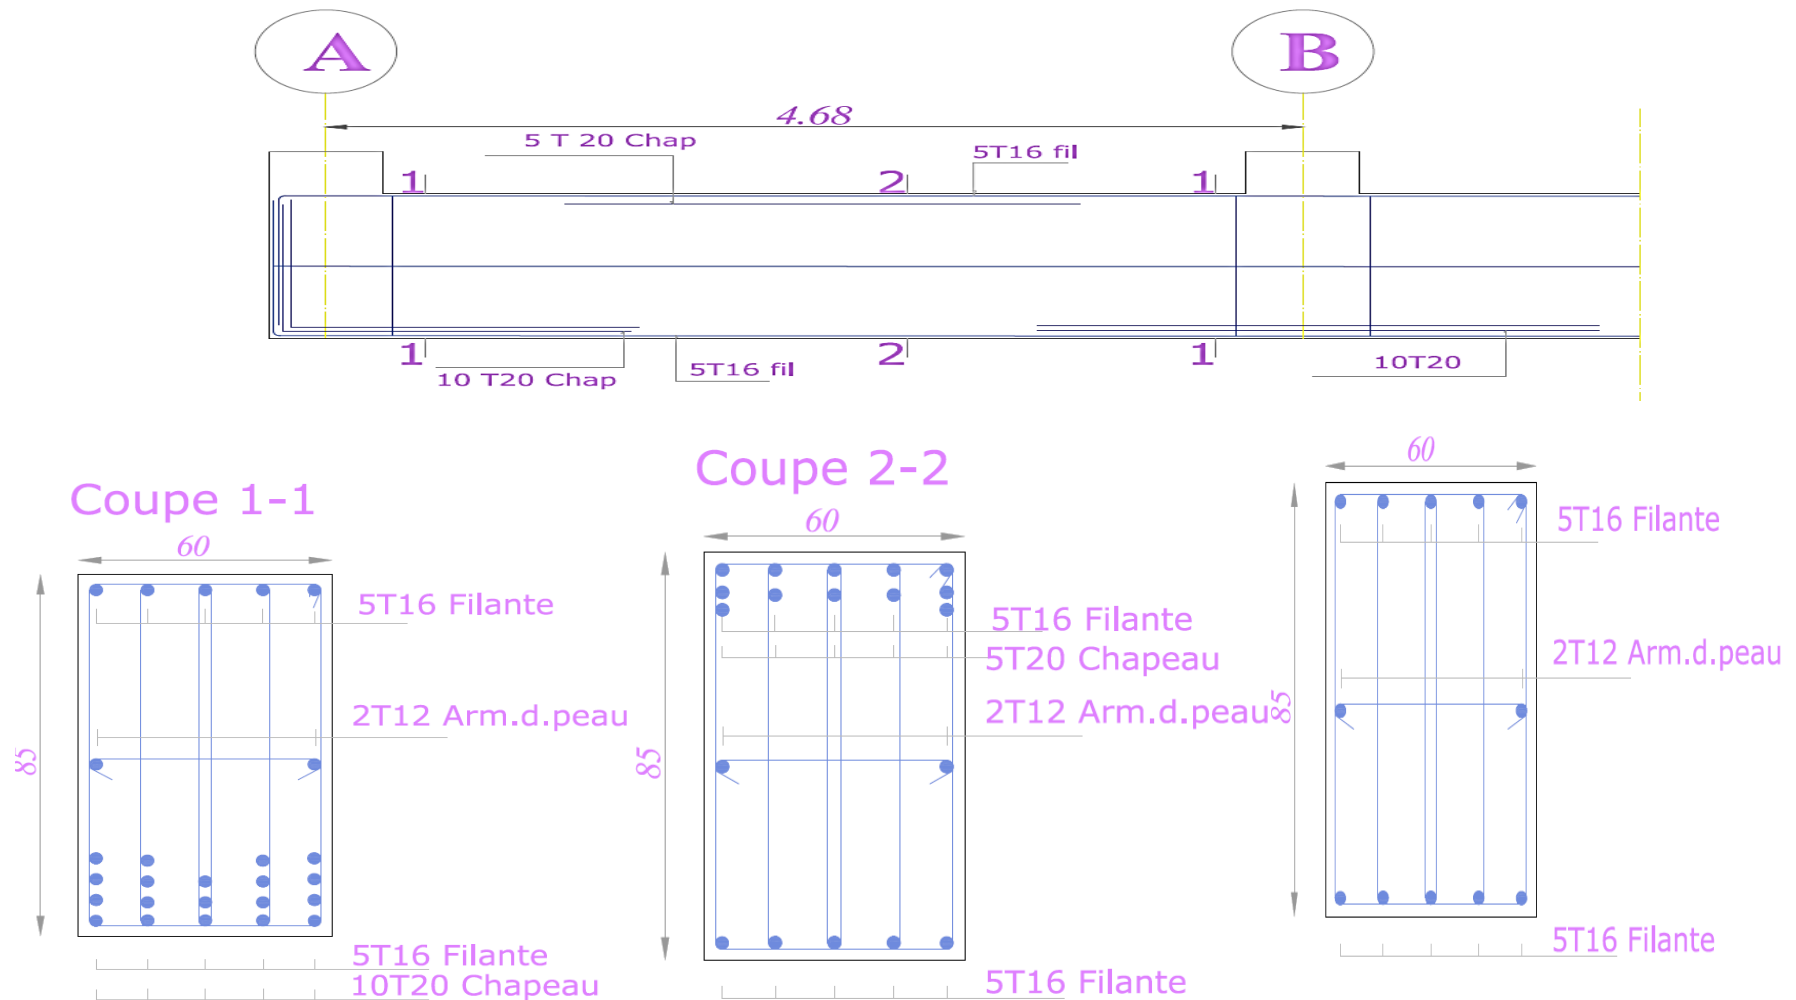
9: Schéma de ferrailage des poutre de rigidité –Principale
